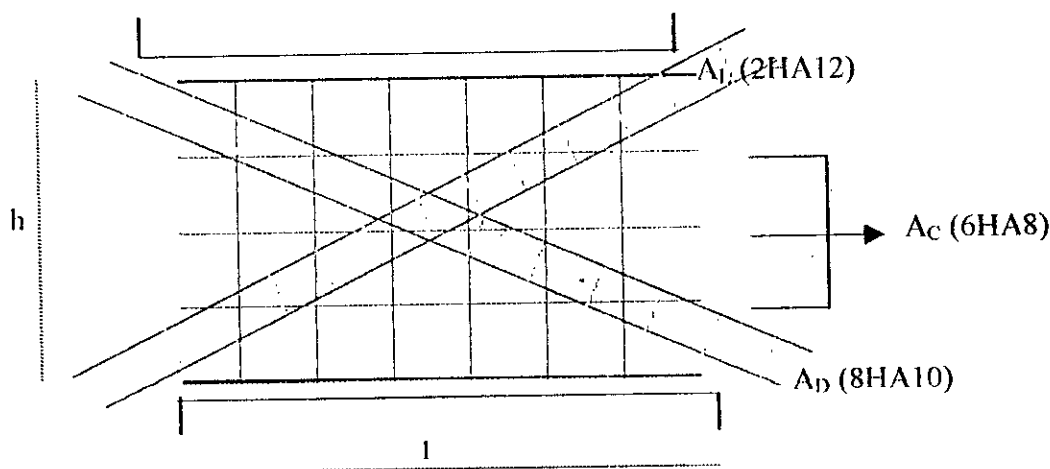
SCHEMA DE FERRAILLAGE DU LINTEAU (1) DE NIVEAU (3)
